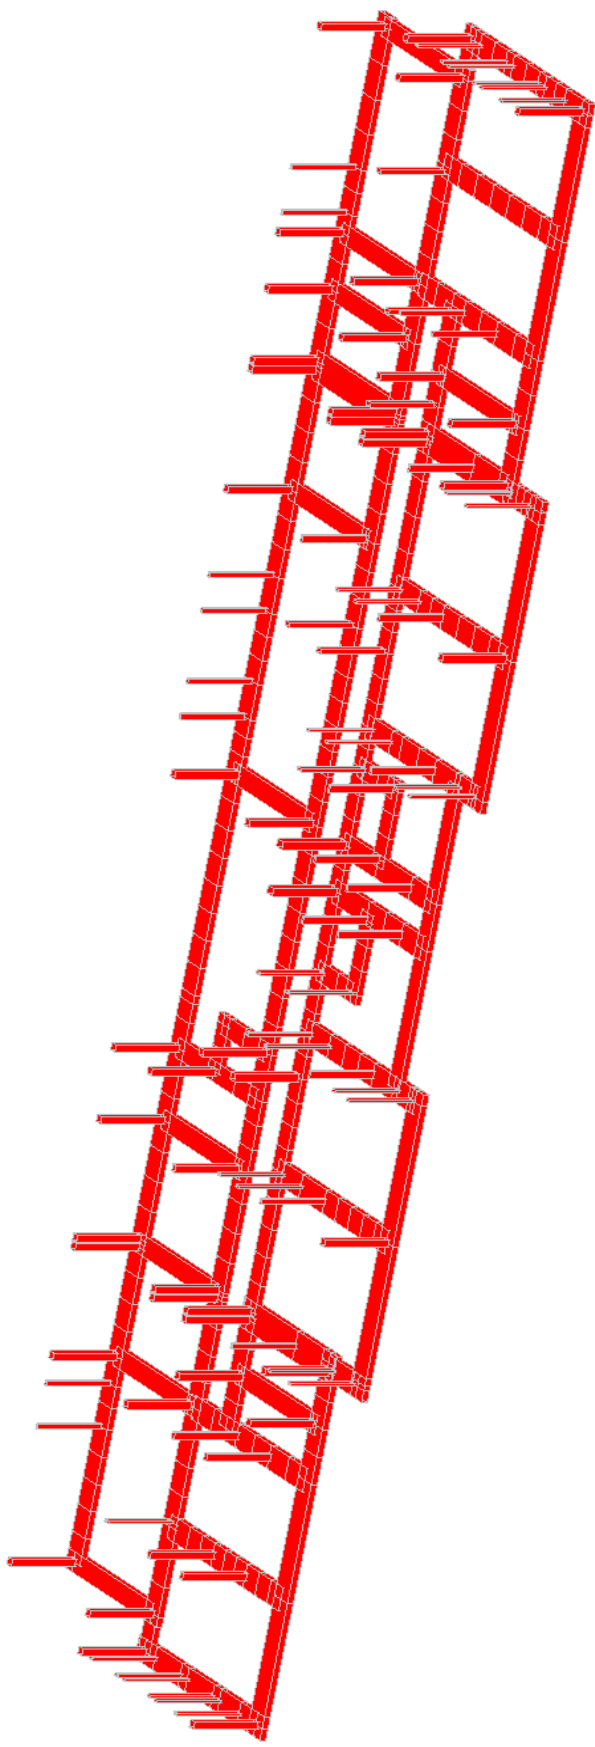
Общий вид ленточного фундамента и железобетонных сердечников в расчетной схеме детского сада
